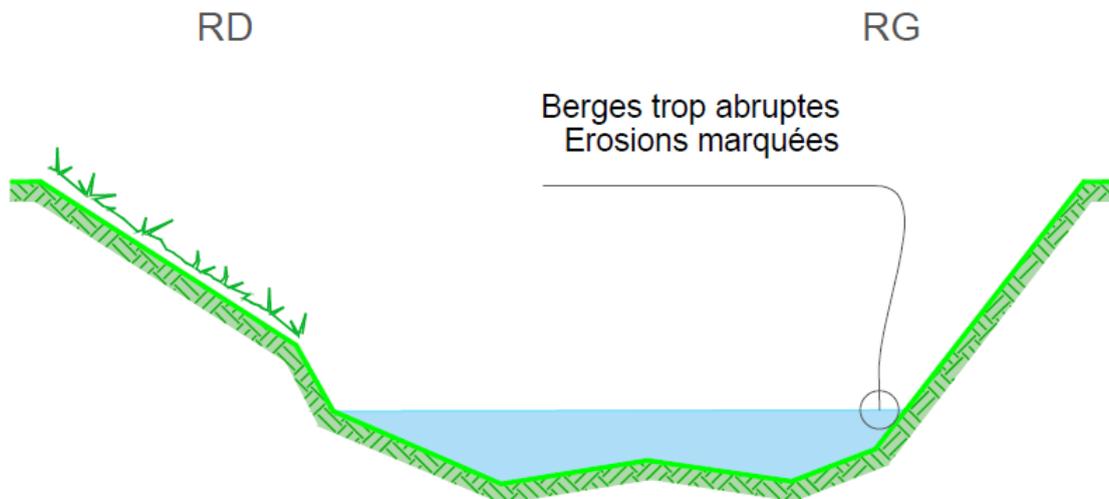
Coupe sur profil 11 représentative du lit existant du bras Sud
